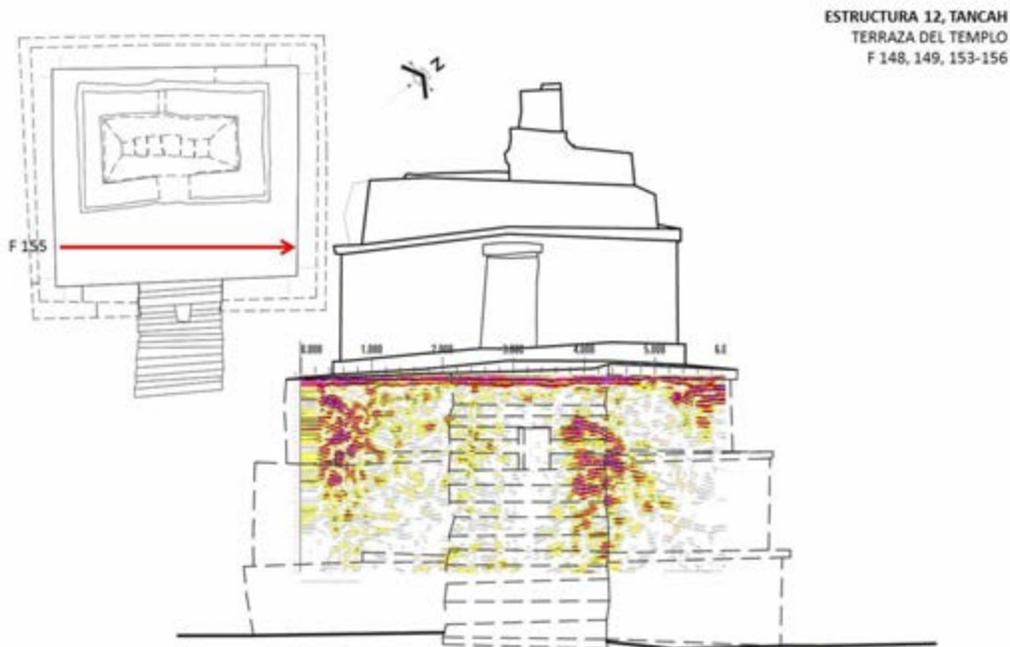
Planta arquitectónica y alzado de la fachada principal de la estructura con la ubicación y vista de las anomalías de la línea 155 de georradar efectuada sobre la terraza superior del basamento. *Imagen: Jorge Blancas, 2015, ©CNCPC-INAH.
